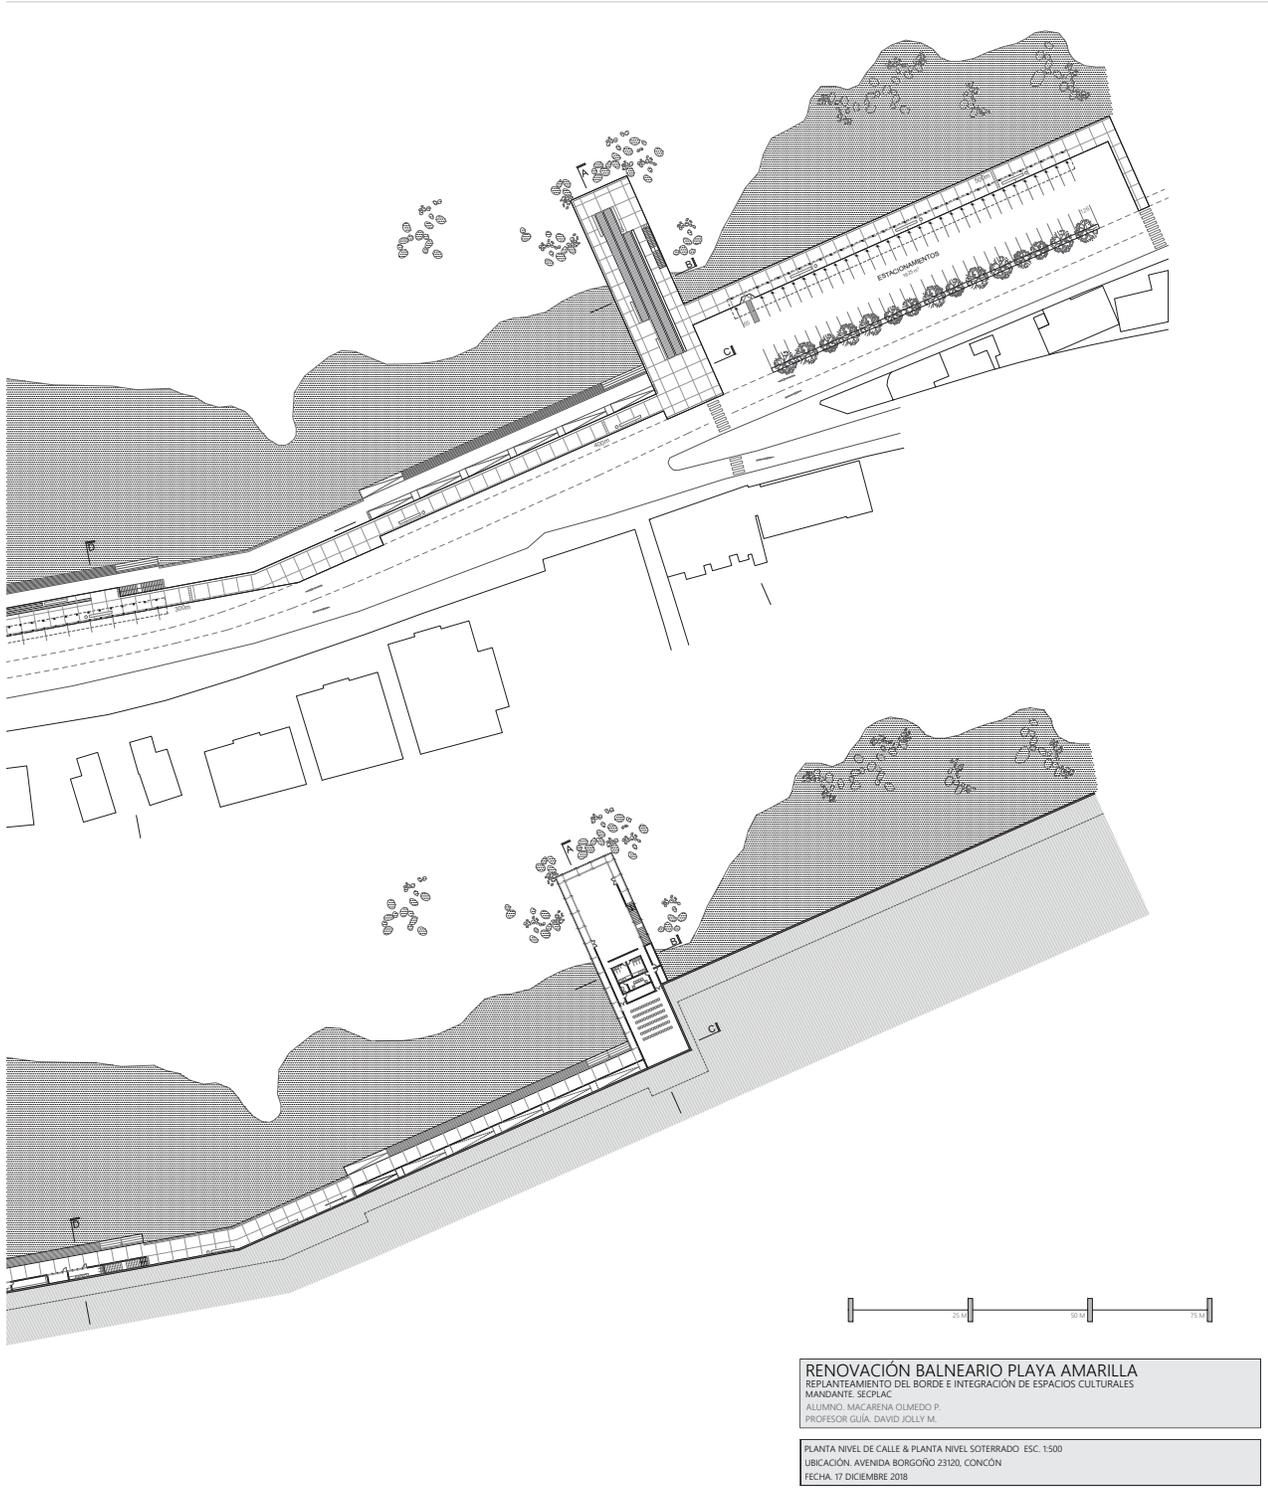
Planta Nivel de calle NTP.0.0 - Planta Nivel Soterrado NTP -3.8.
